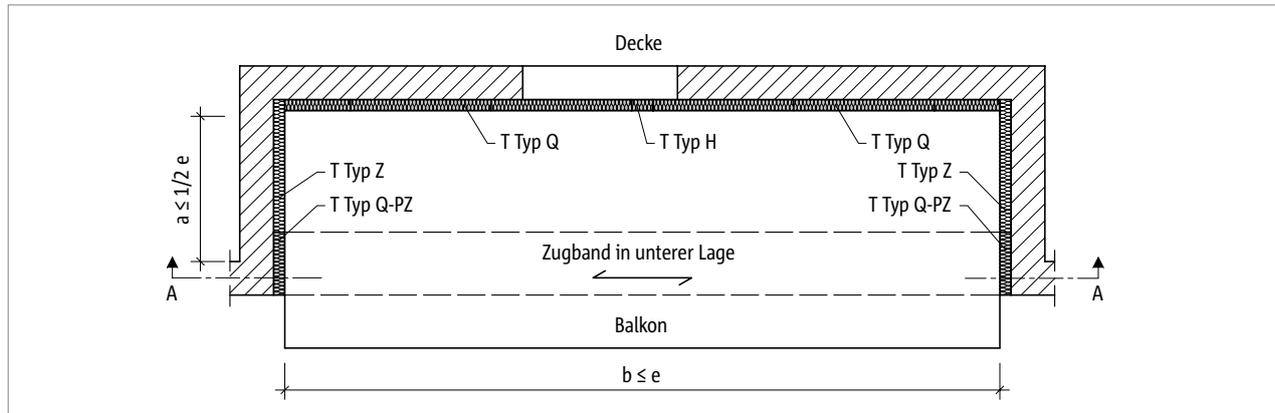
Schöck Isokorb® T Typ Q-PZ, Q: Grundriss Loggia
